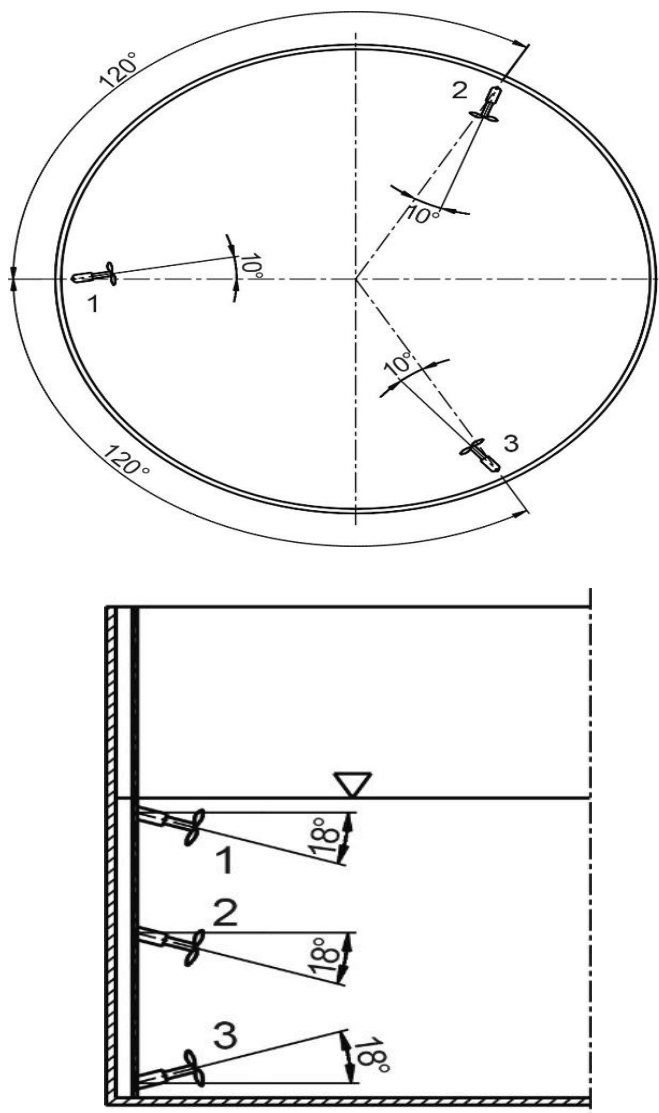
Obecná geometrická konfigurace fermentoru s etážovým míchadlem [20]
